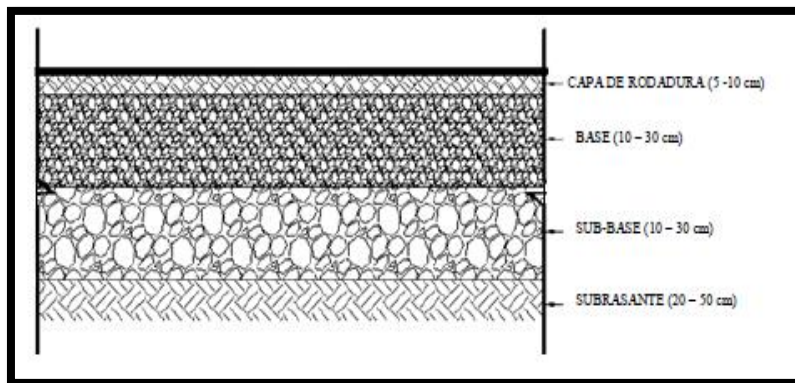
Sección transversal de un pavimento flexible (Bilbao, 2014).
